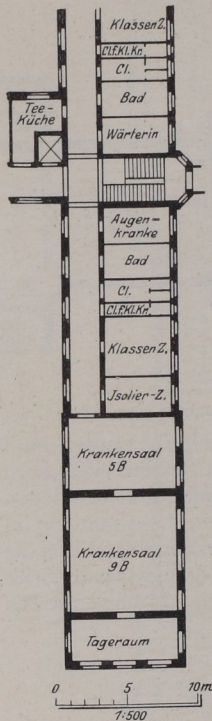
Frankfurt a. O., städt. Krankenhaus, Bettenhaus.
